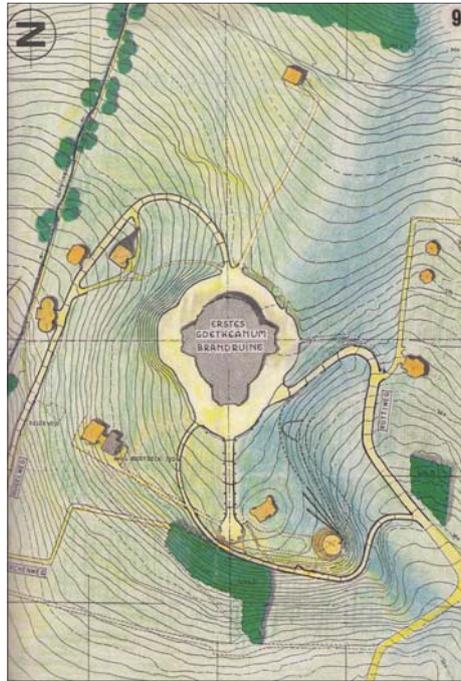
Rudolf Steiner - Planimetria terreno collina di Dornach, Edifici di RST. Dornach, Svizzera.
